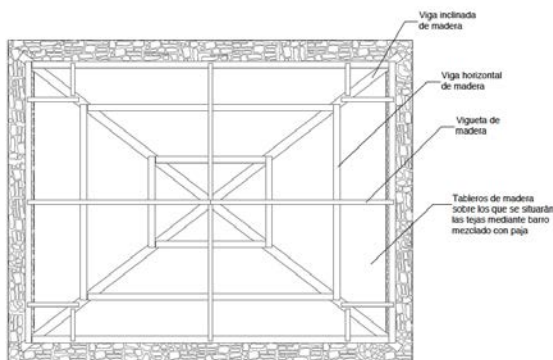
Planta de la cubierta sobre el crucero (Mª P. Mata)
